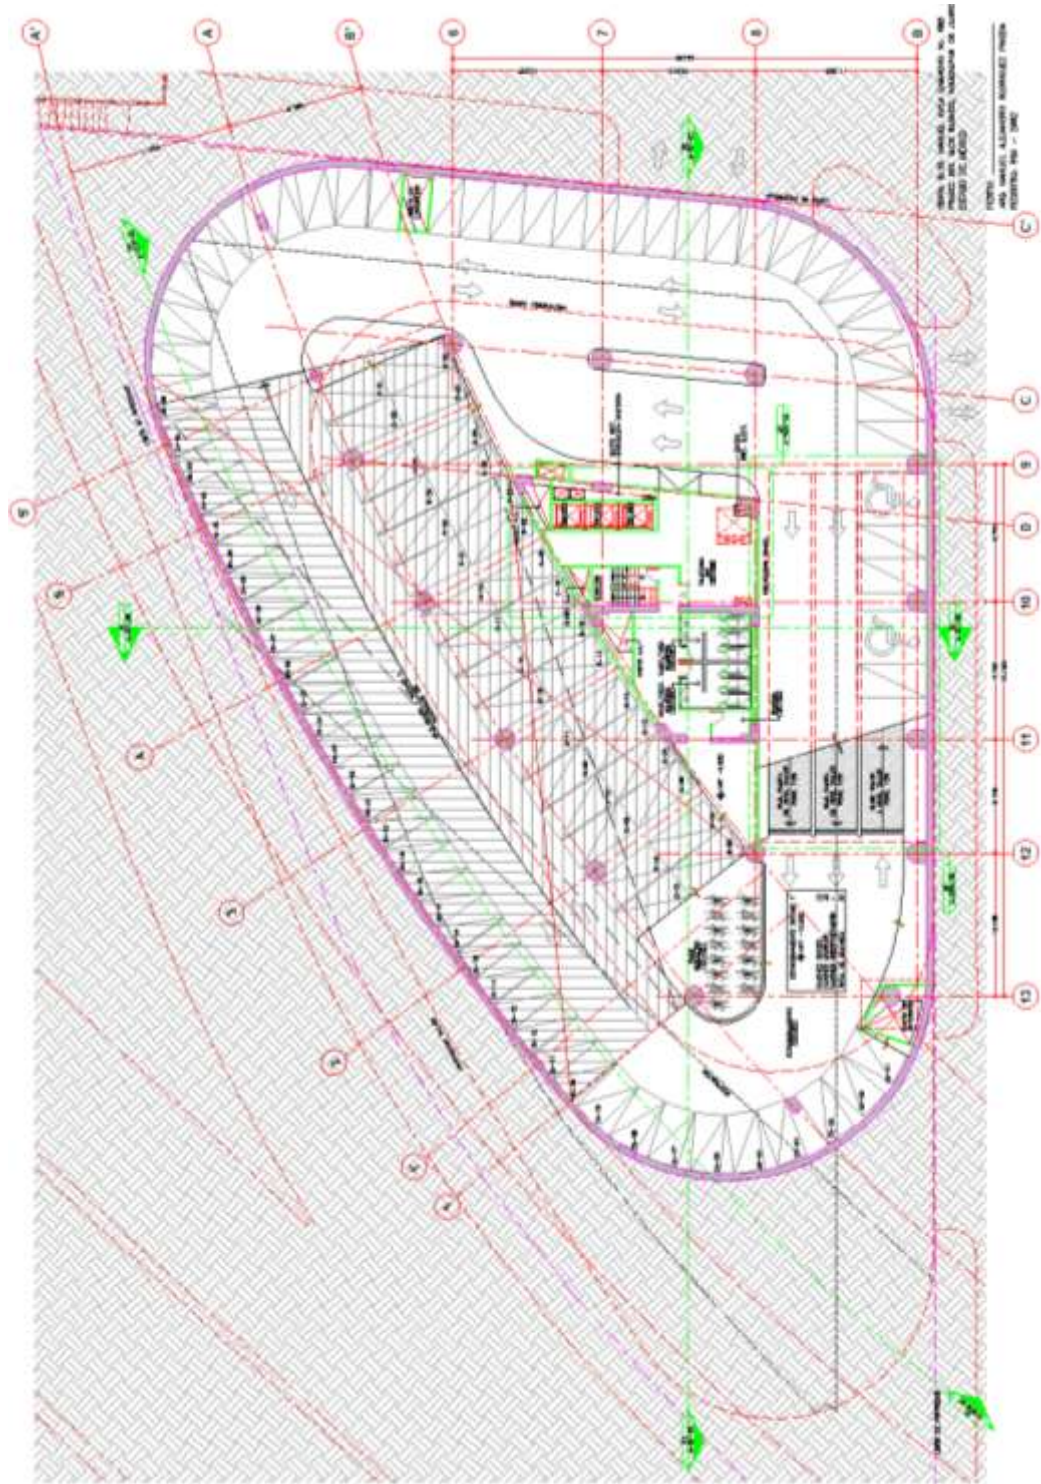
ANTEPROYECTO PLANTA ARQUITECTONICA SOTANO 1
